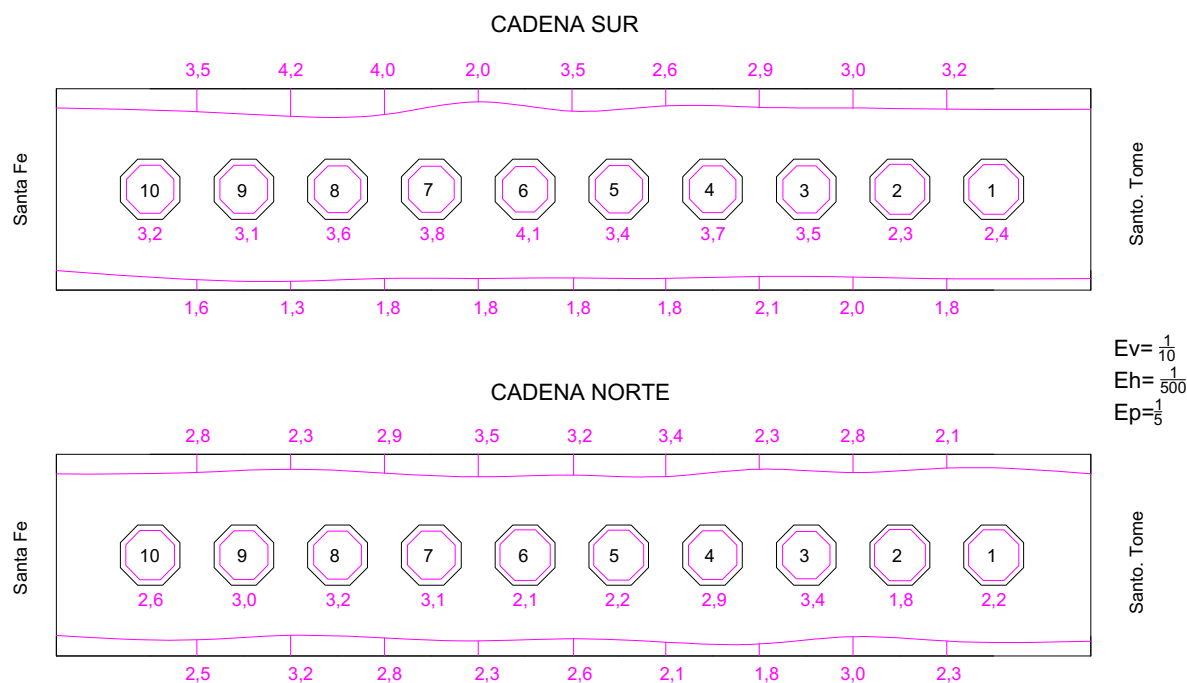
Determinación de carbonatación en hormigón de recubrimiento retirado.
